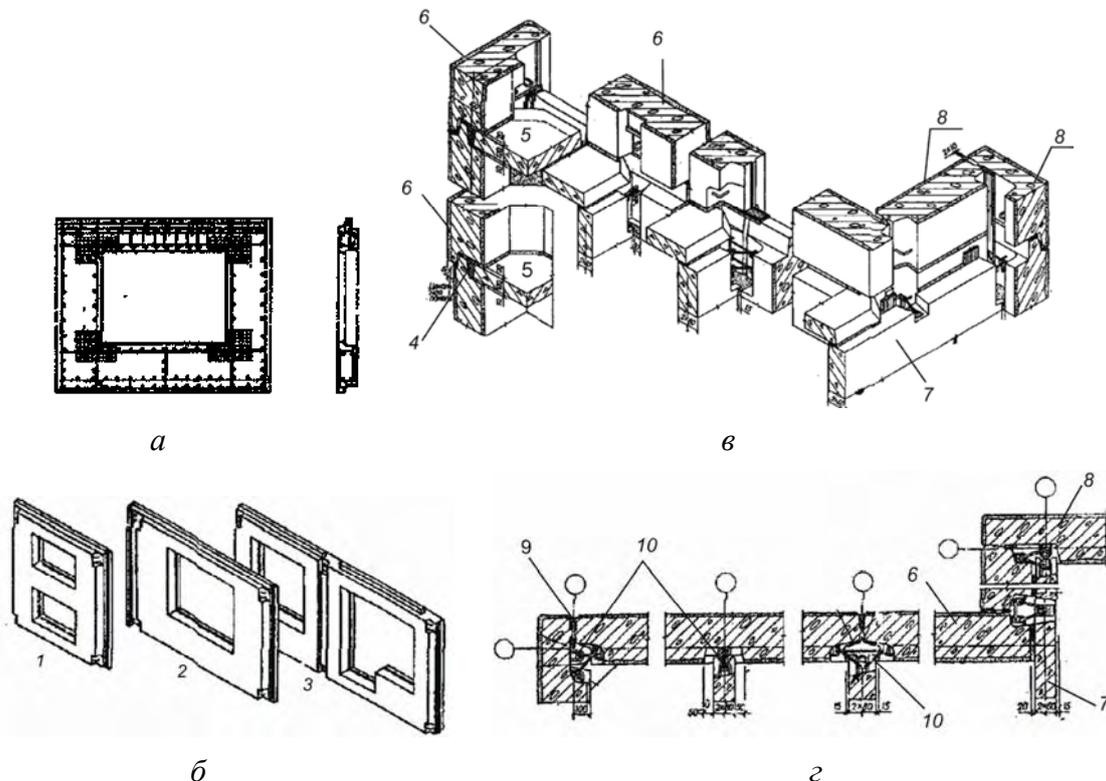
Наружные стены из однослойных панелей однокорпусной разрезки зданий высотой до 9 этажей (по серии 1.132-1): *а* — схема конструктивного армирования; *б* — продольные стеновые панели; *в* — детали сопряжений; *г* — план по верху панелей: 1 — продольная стеновая панель лестничной клетки; 2 — продольная панель у торца ризолита; 3 — продольная рядовая панель размером на 2 комнаты; 4 — термовкладыш; 5 — междуэтажная плита; 6 — наружная стеновая панель; 7 — внутренняя стеновая панель; 8 — панель ризолита; 9 — герметизирующая мастика; 10 — соединительные скобы
